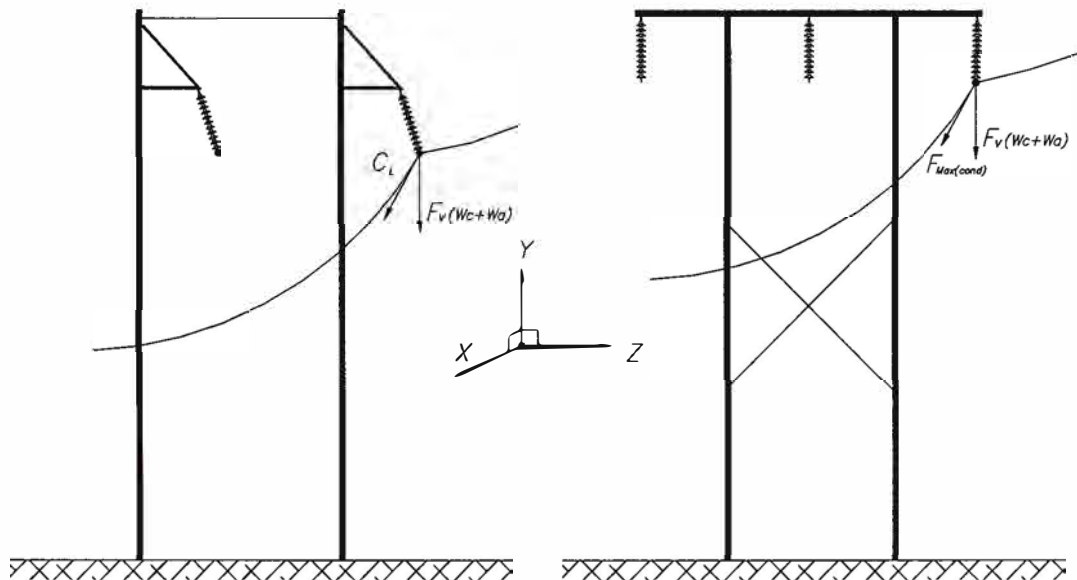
Cargas aplicadas a los aisladores en la estructura tipo HA1 y HS
